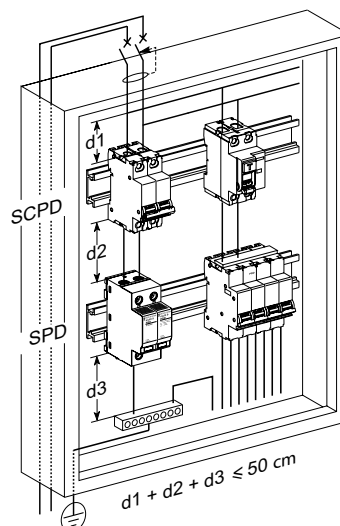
Příklady vhodné a nevhodné instalace svodičů přepětí
